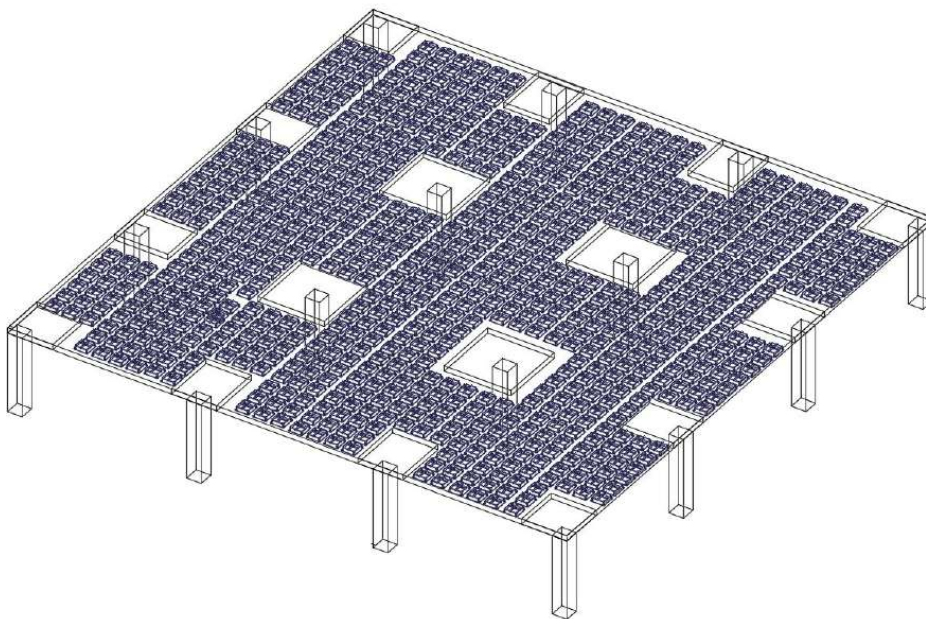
1 - Losa aligerada con el sistema U-BOOT
